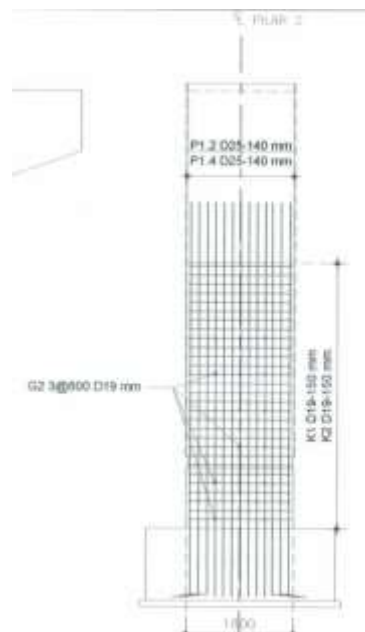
15. Tampak Atas detail penulangan pier 2
